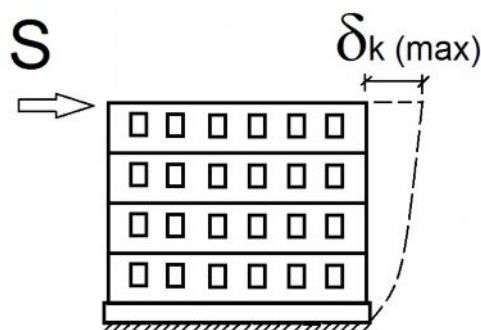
Схема перемещения здания. S – сейсмическая сила, действующая на здание; δ_{kmax} – величина перемещения k -го этажа здания
